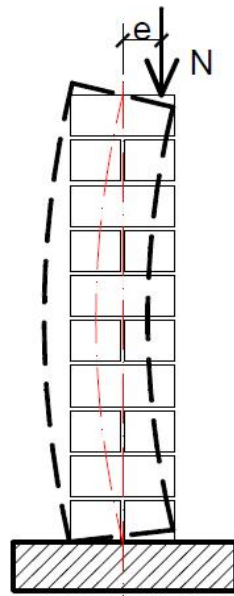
Shkaterrimi nga përkulja jashtë planit të muraturës
